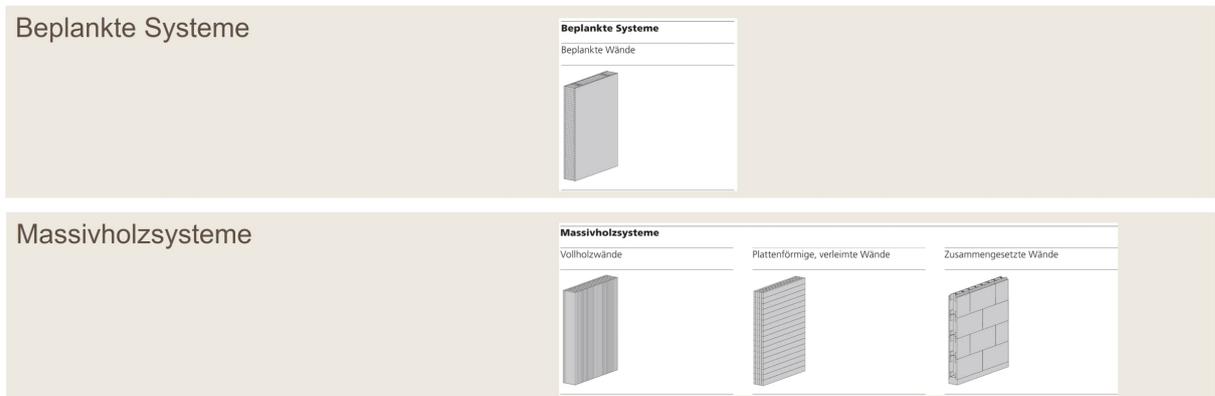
Einordnung Aussenwandkonstruktionen nach Bauteilsystemen [2]
